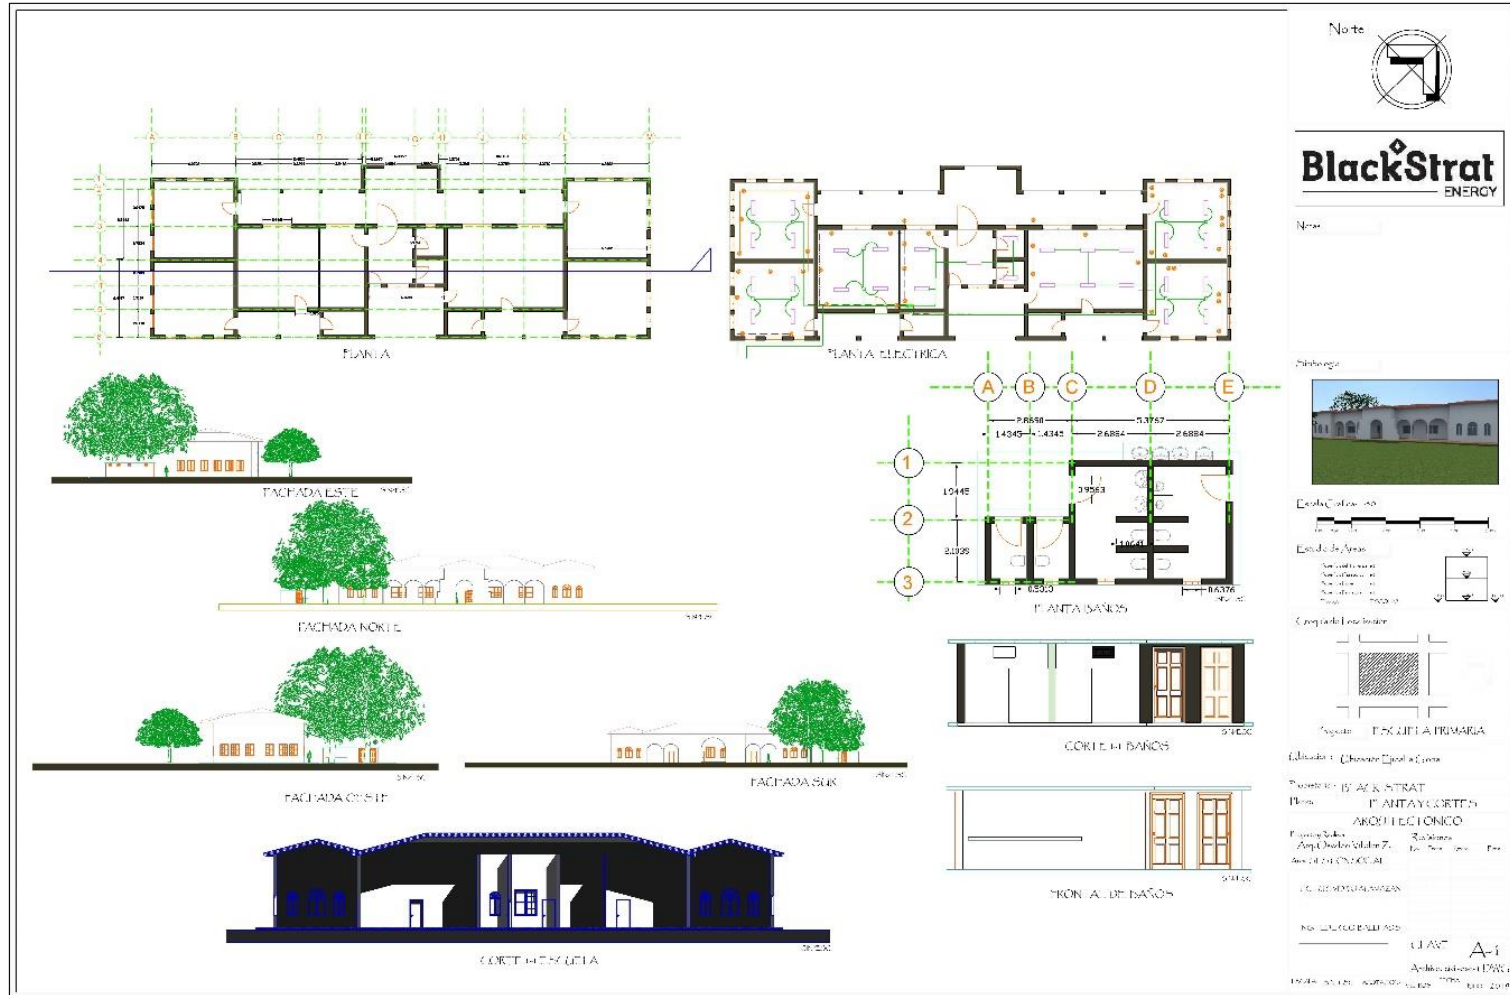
Plano de planta de la escuela primaria Lázaro Cárdenas
